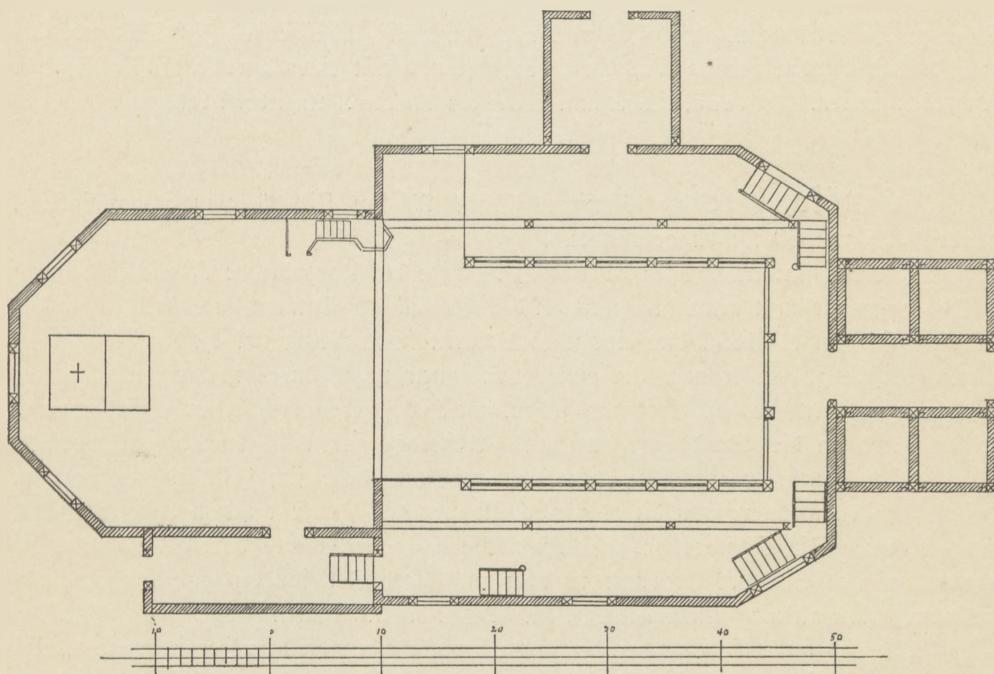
Grundriss der abgebrochenen Kirche zu Groß-Rosinsko.
